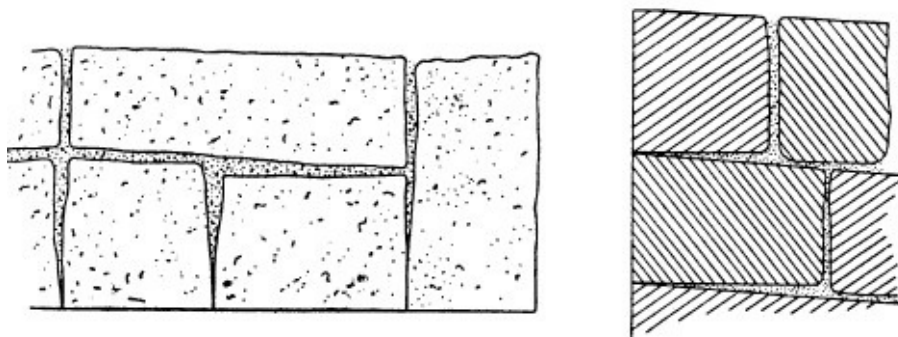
План и разрез кладки из небольших блоков. Саккара, эпоха фараона Джосера
